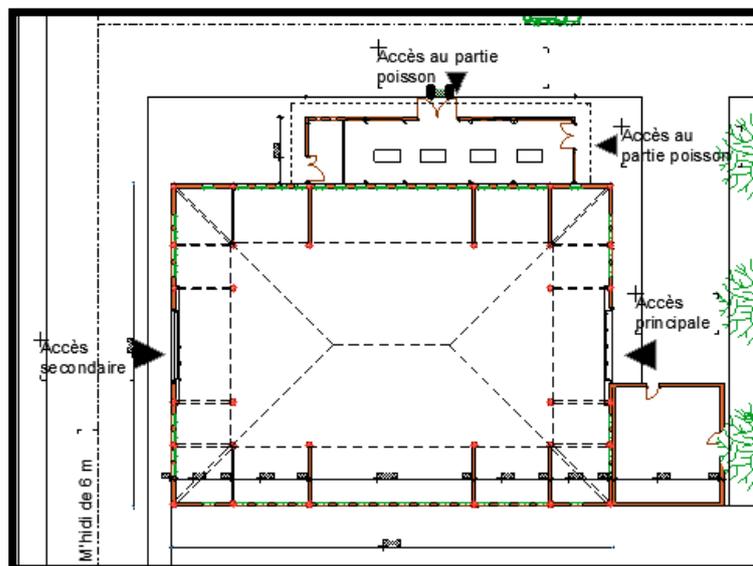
représente le plan du R.D.C du marché couvert. (Source : auteur).
